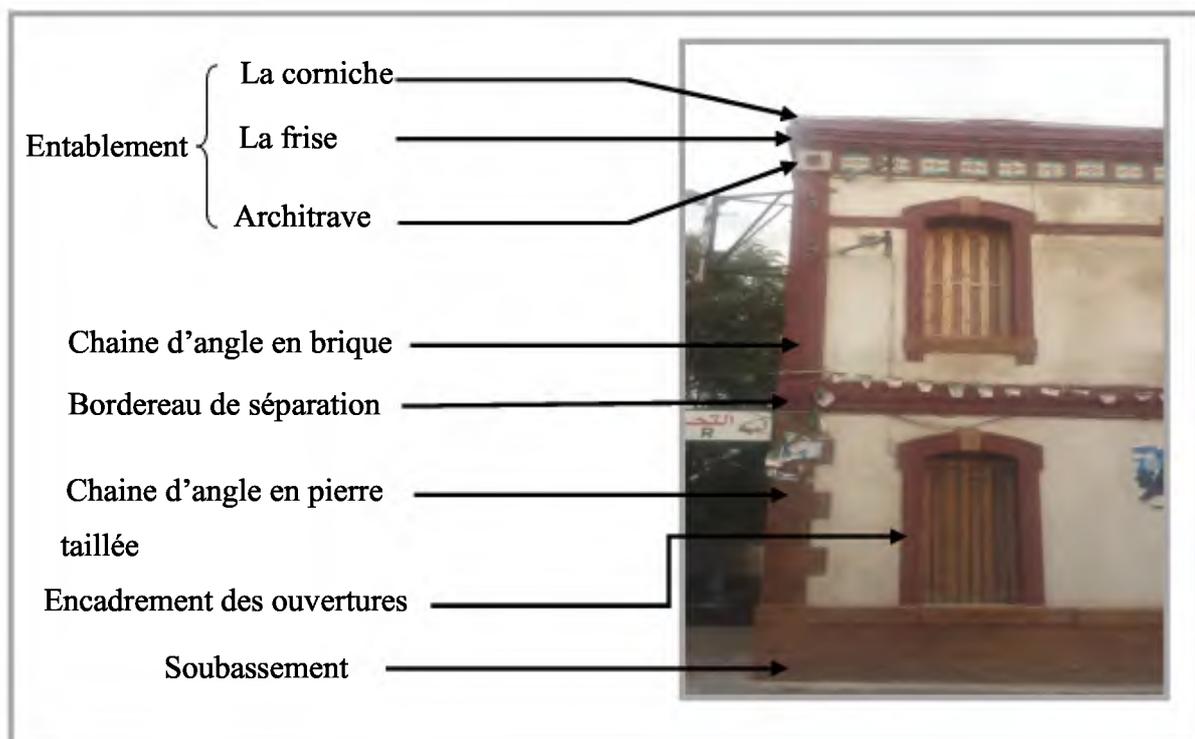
lecture architecturale de la façade principale de l'hôtel de ville
